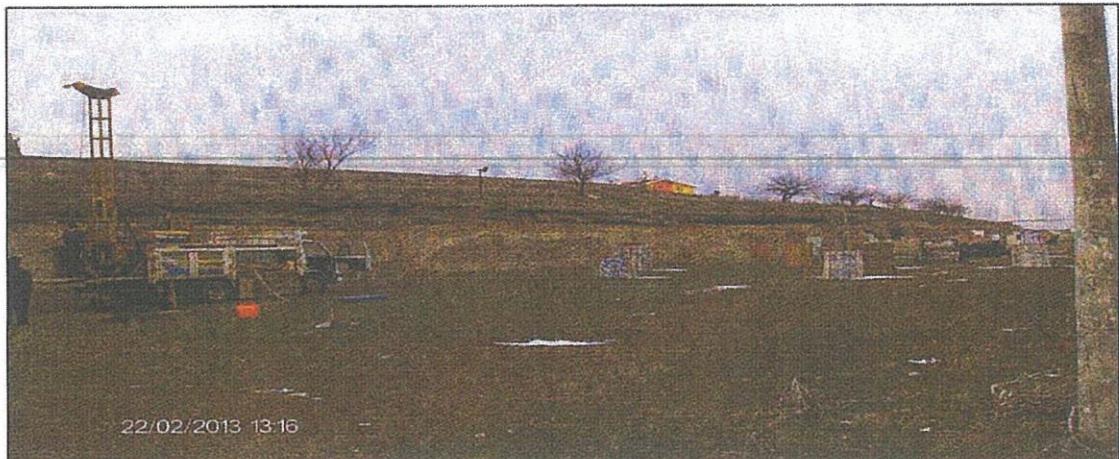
SK-2'de yapılan sondaj çalışmasından görünüm(D500)
